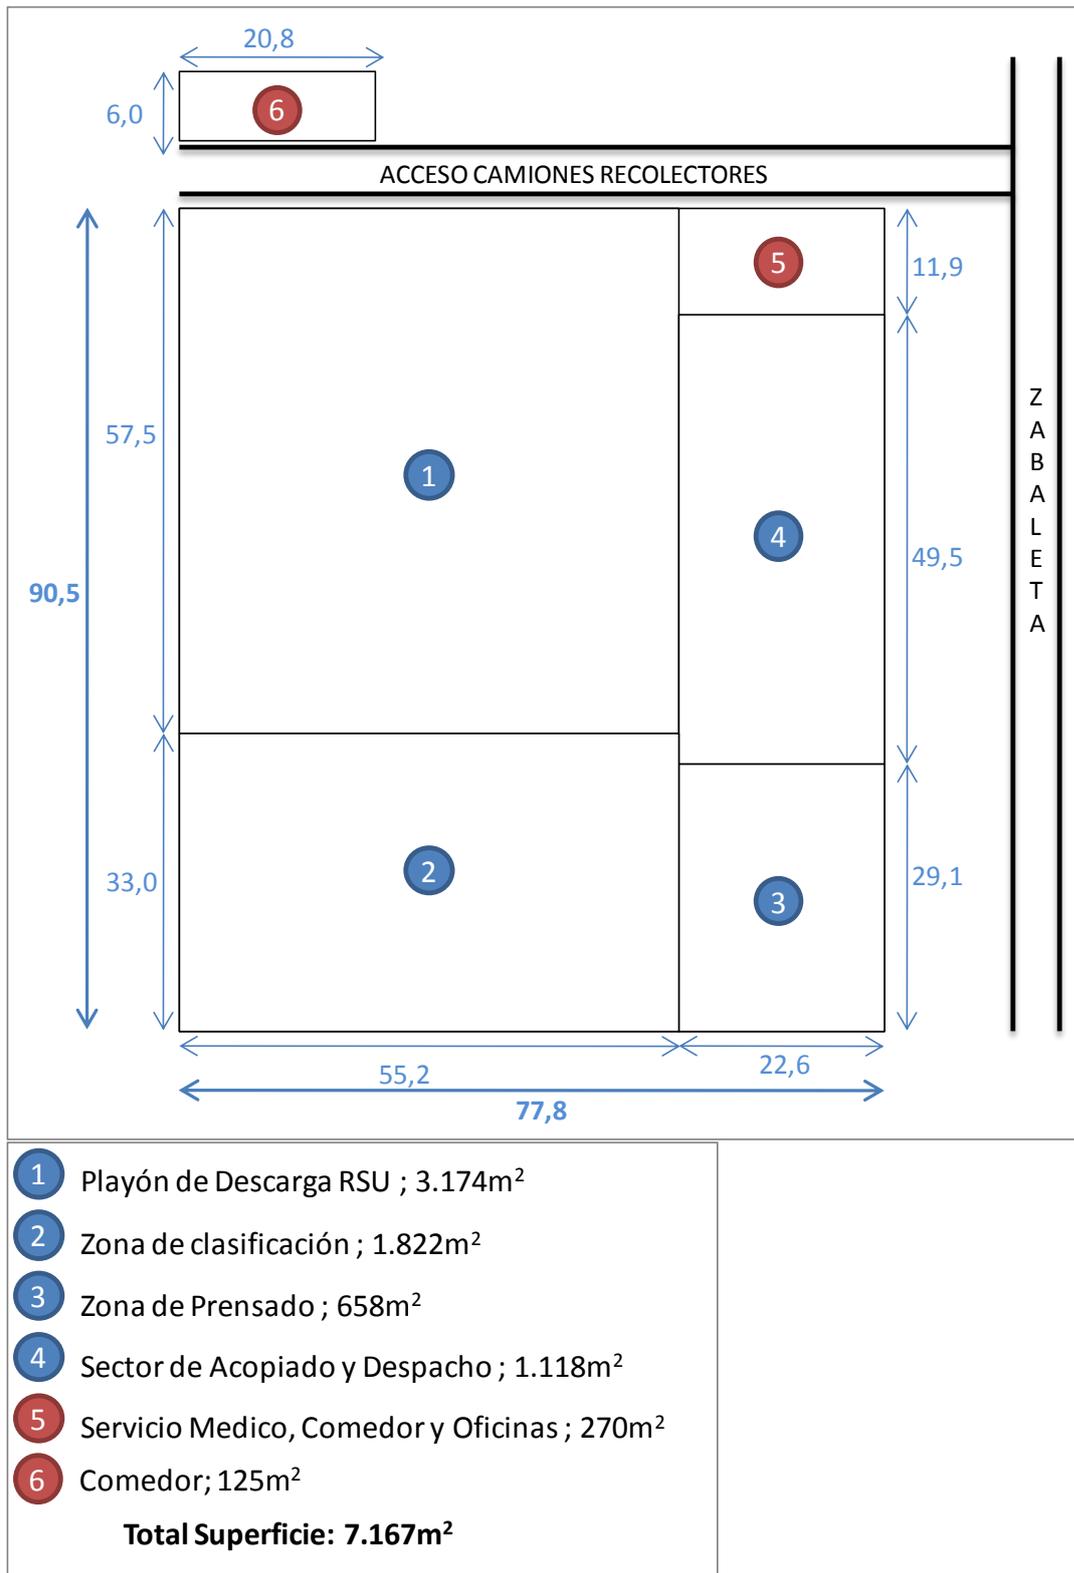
a Plano de la Planta de Separación y Clasificación
